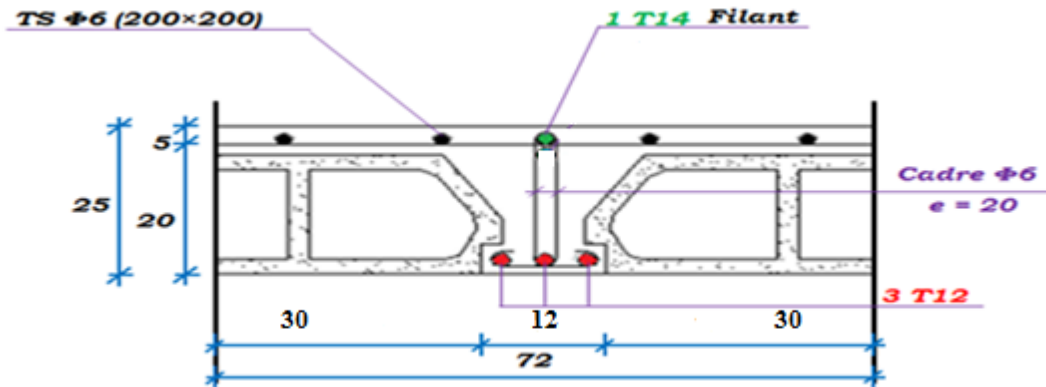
Coupe De Ferrailage Plancher Terrasse 2 Travées
